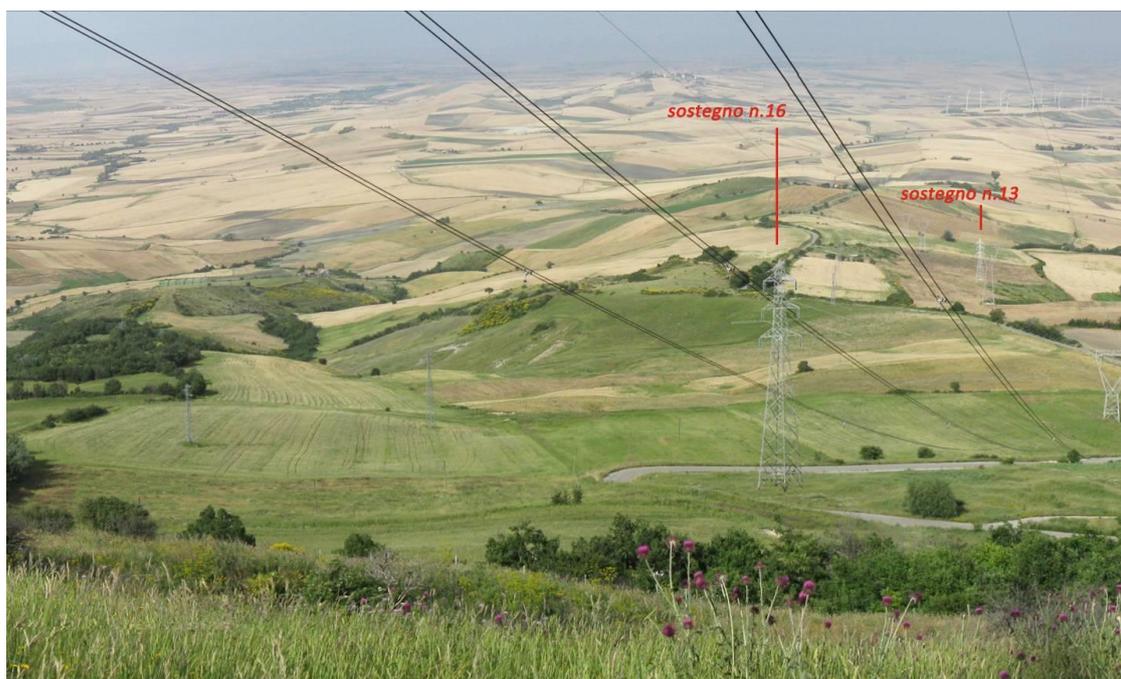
Il sostegno 16 (in primo piano) ed il 13 (sullo sfondo) si raccordano alla strada esistente con brevi tratti di pista in piano
